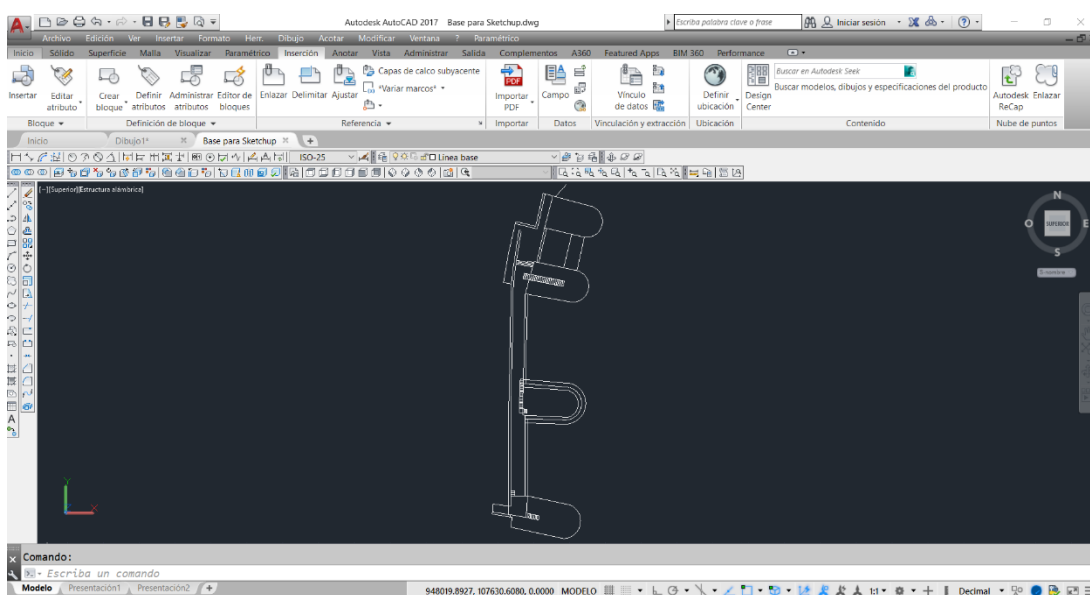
Planimetría muralla actual Puerta de Alcázar.
